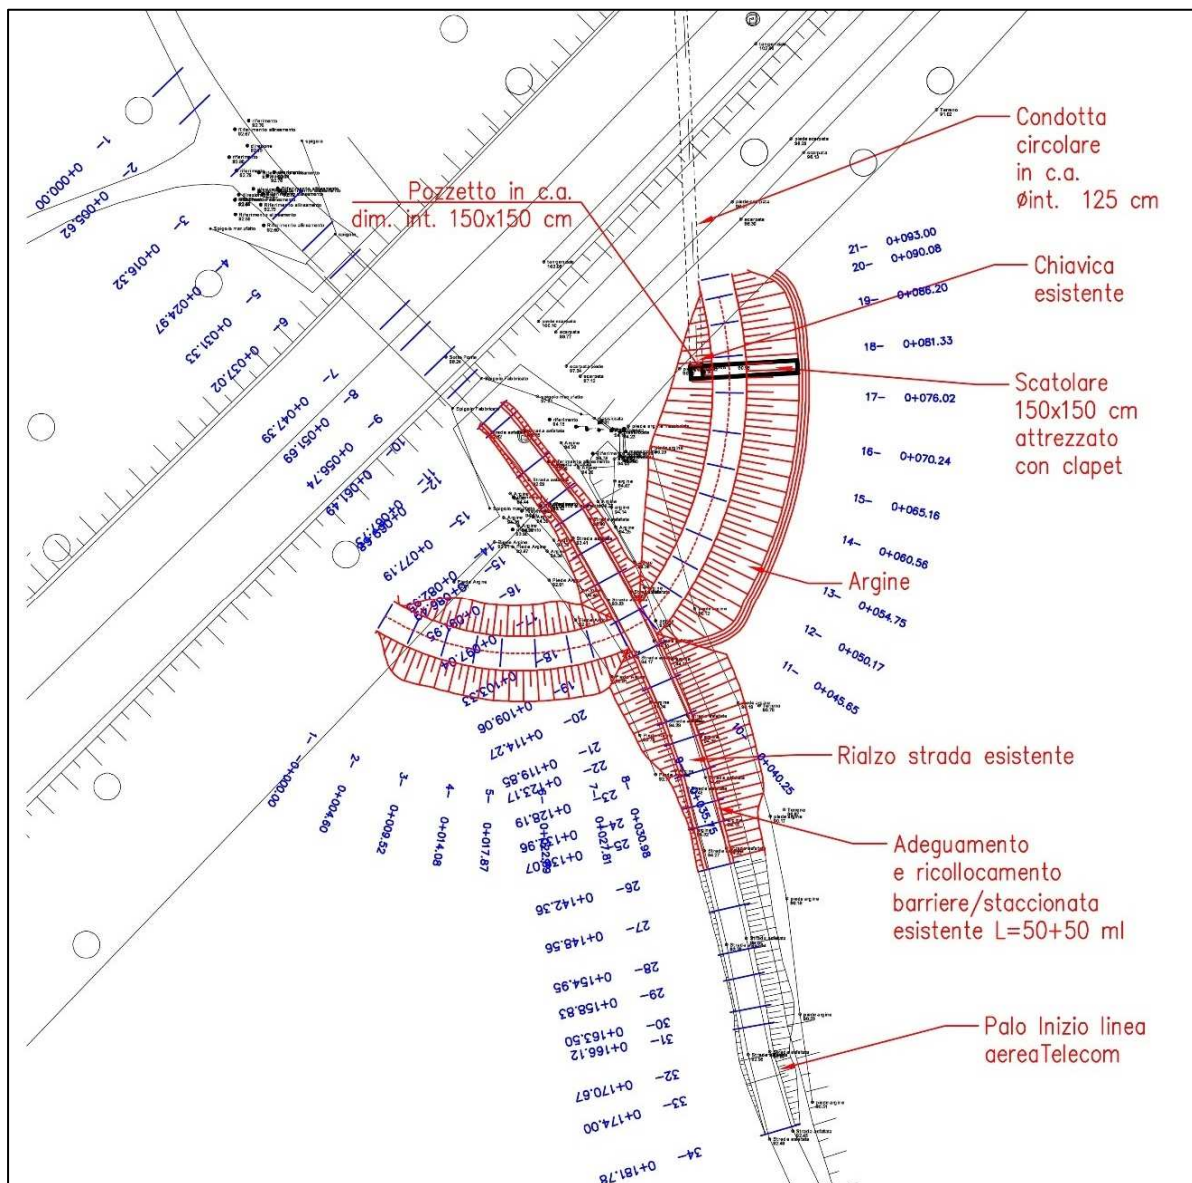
Arginatura chiusura fornice ramo sud Via del Chiozzetto – Planimetria
